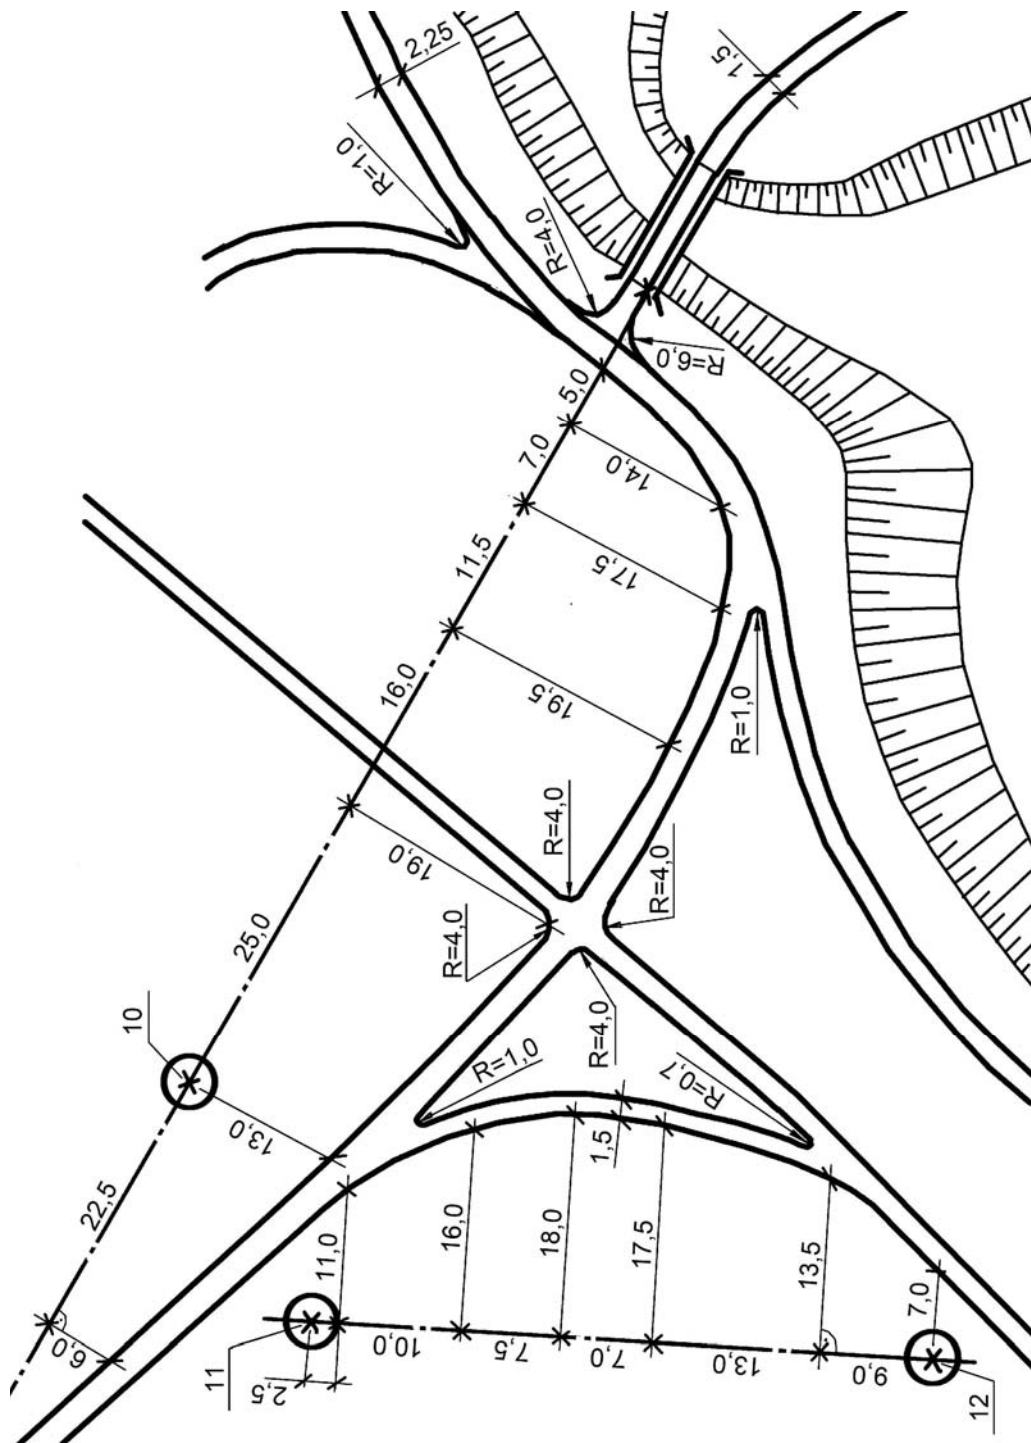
Пример выполнения разбивочного чертежа планировки (метод ординат)
